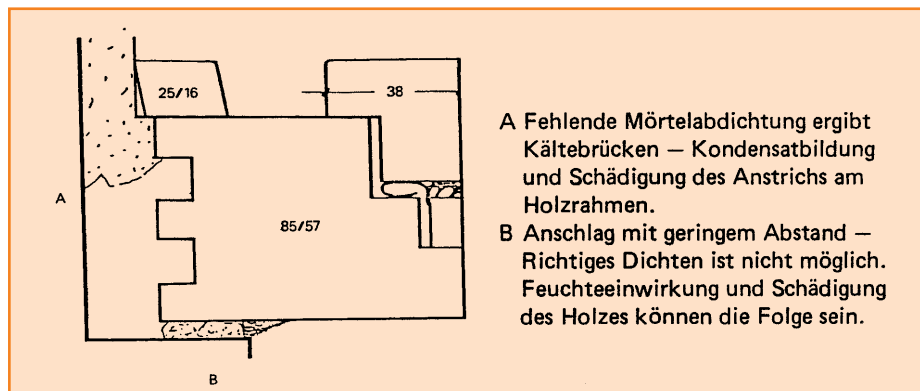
Baukörperanschluß mit fehlender Dichtung und in der Tiefe zu geringer Fuge
